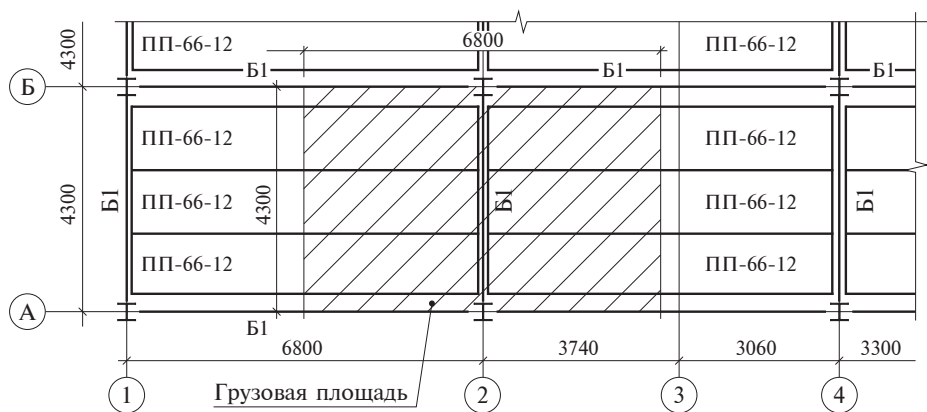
Фрагмент схемы расположения балок и сборных плит перекрытий.
